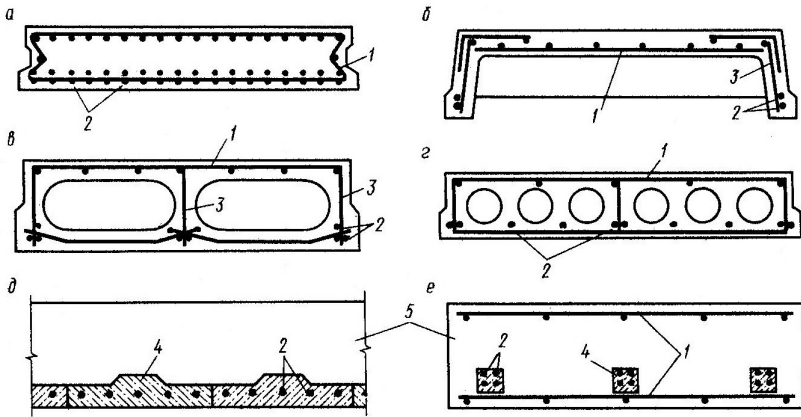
Поперечные сечения сборных и сборно-монолитных плит: *a* – сплошная плита; *б* – ребристая плита; *в*, *г* – пустотные плиты; *д*, *е* – сборно-монолитные плиты; 1 – сварные сетки; 2 – рабочая арматура; 3 – плоские каркасы; 4 – сборные элементы (армоземнты); 5 – монолитный бетон
